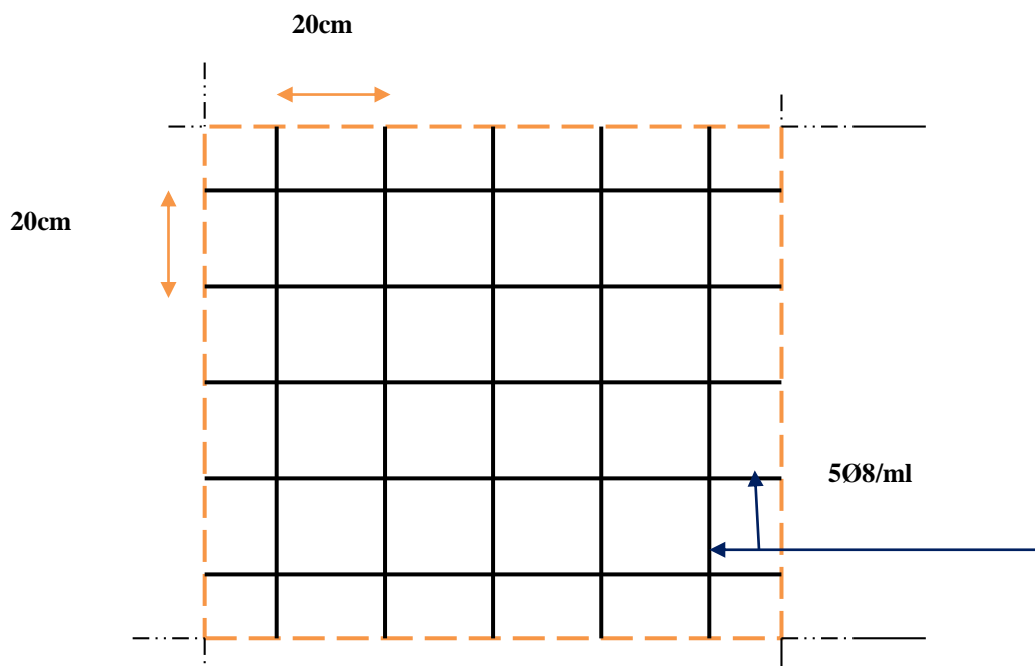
Schéma de ferraillage de la dalle de compression.
